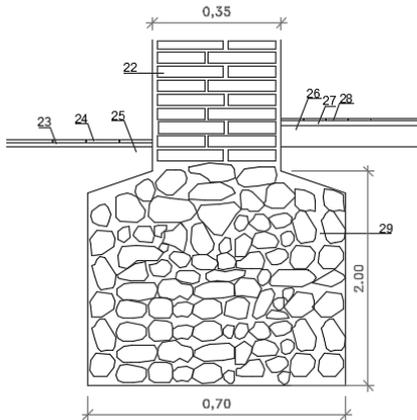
Detalle constructivo Arranque Cimentación-Muro. Fuente: Propia de la autora
